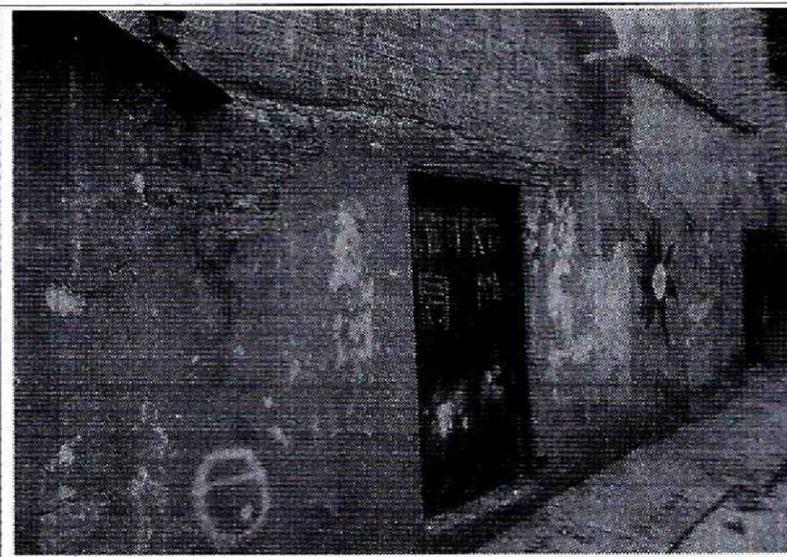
Deterioro en el extremo norte del muro de fachada del costado oriental.
